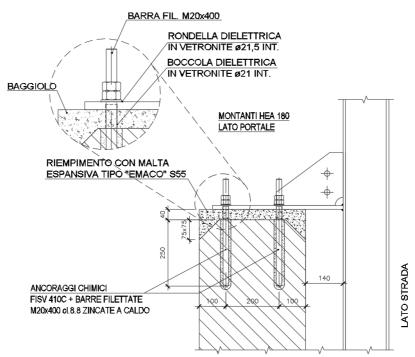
Dettaglio del collegamento superiore HEA180 alto della barriera testata galleria
